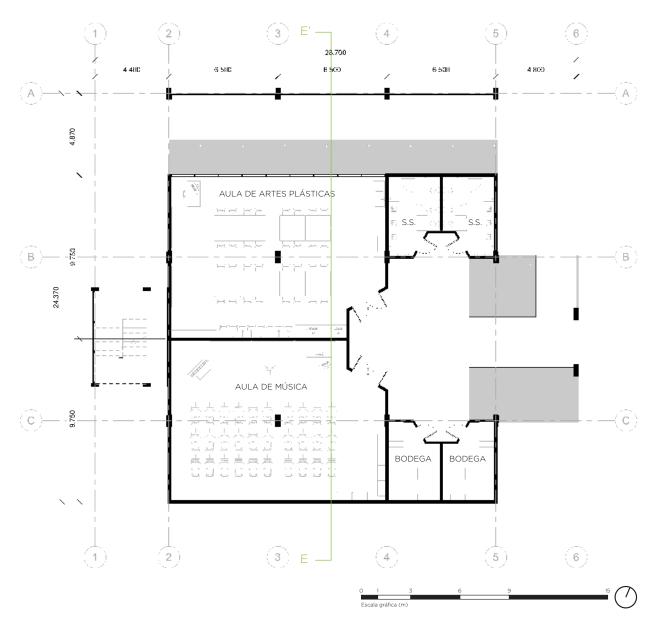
Planta arquitectónica de los talleres y laboratorios NPT 0,00 - 5,90 m
